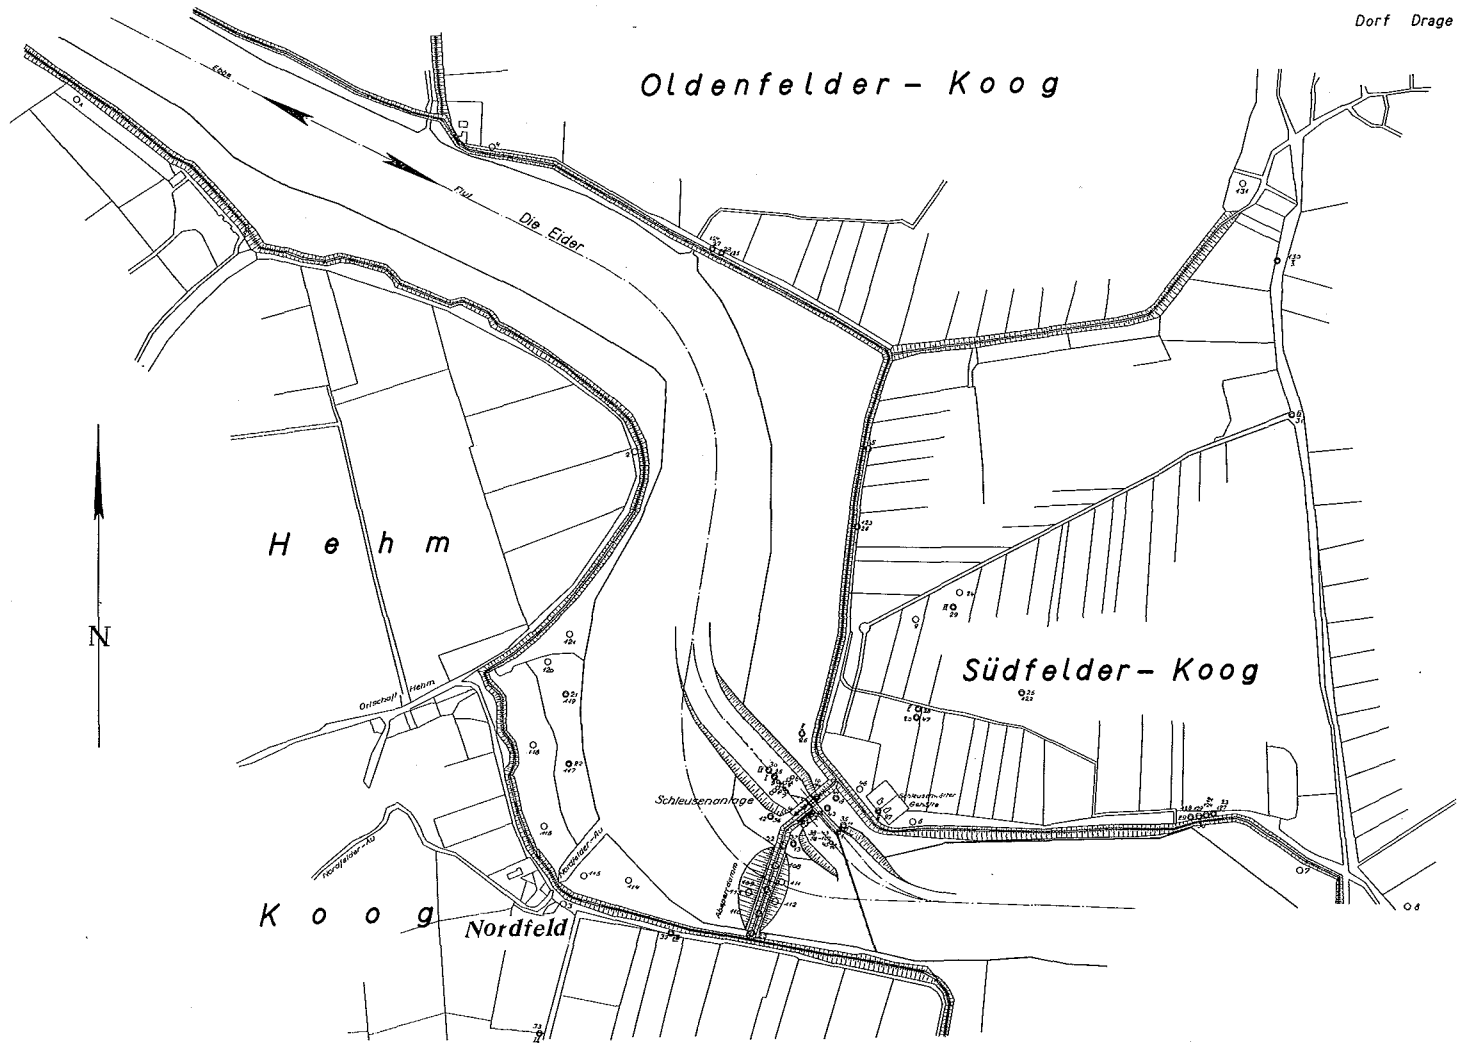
Lageplan der Schleusenbaustelle und der Abdämmung bei Nordfeld.
